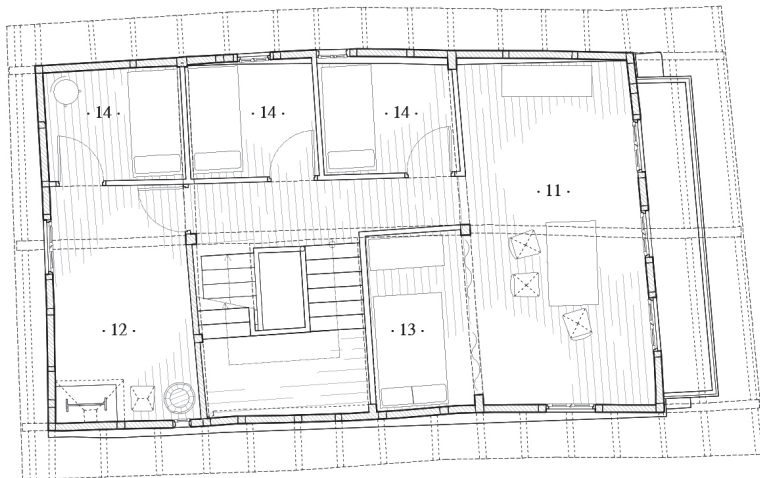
Planimetría actual de la casa. / Current plans of the house.
